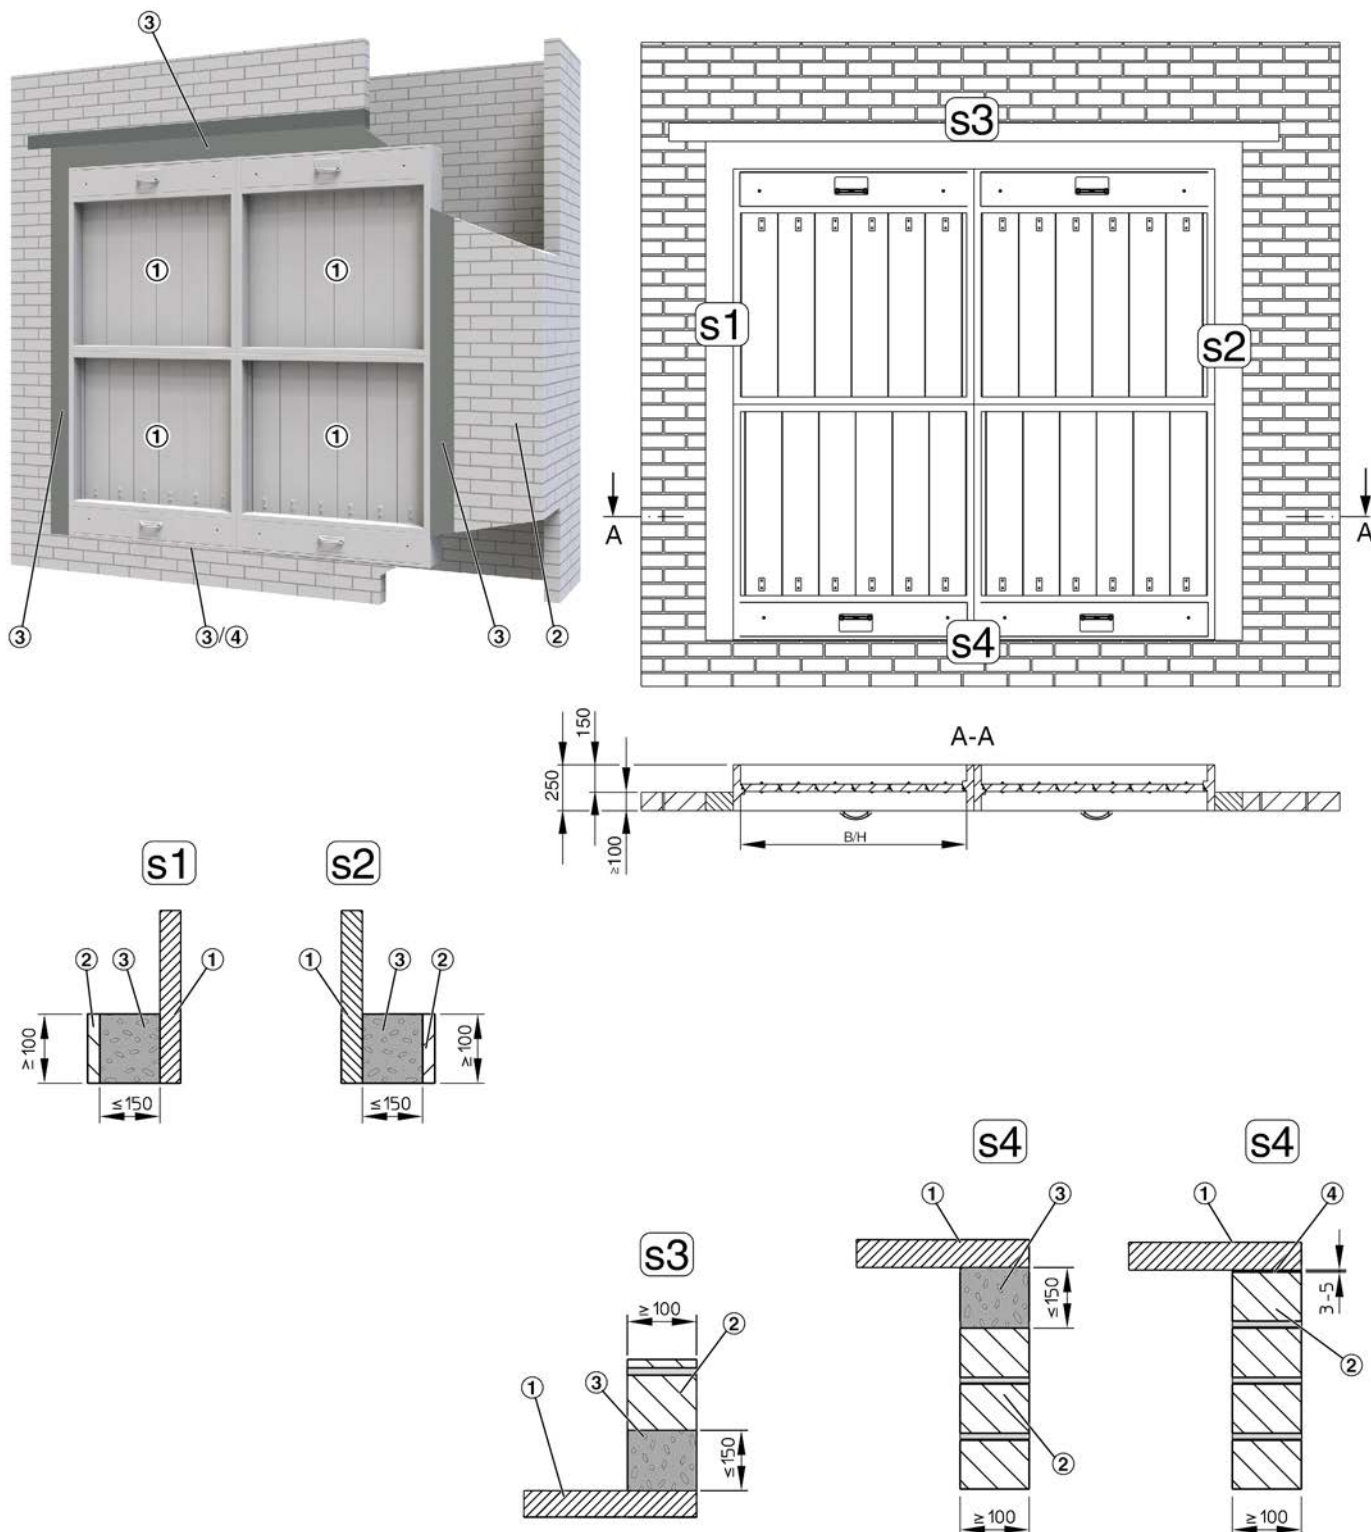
Disposizione quadrupla EK-JZ, installazione a base di malta in una parete piena o parete solida cava
